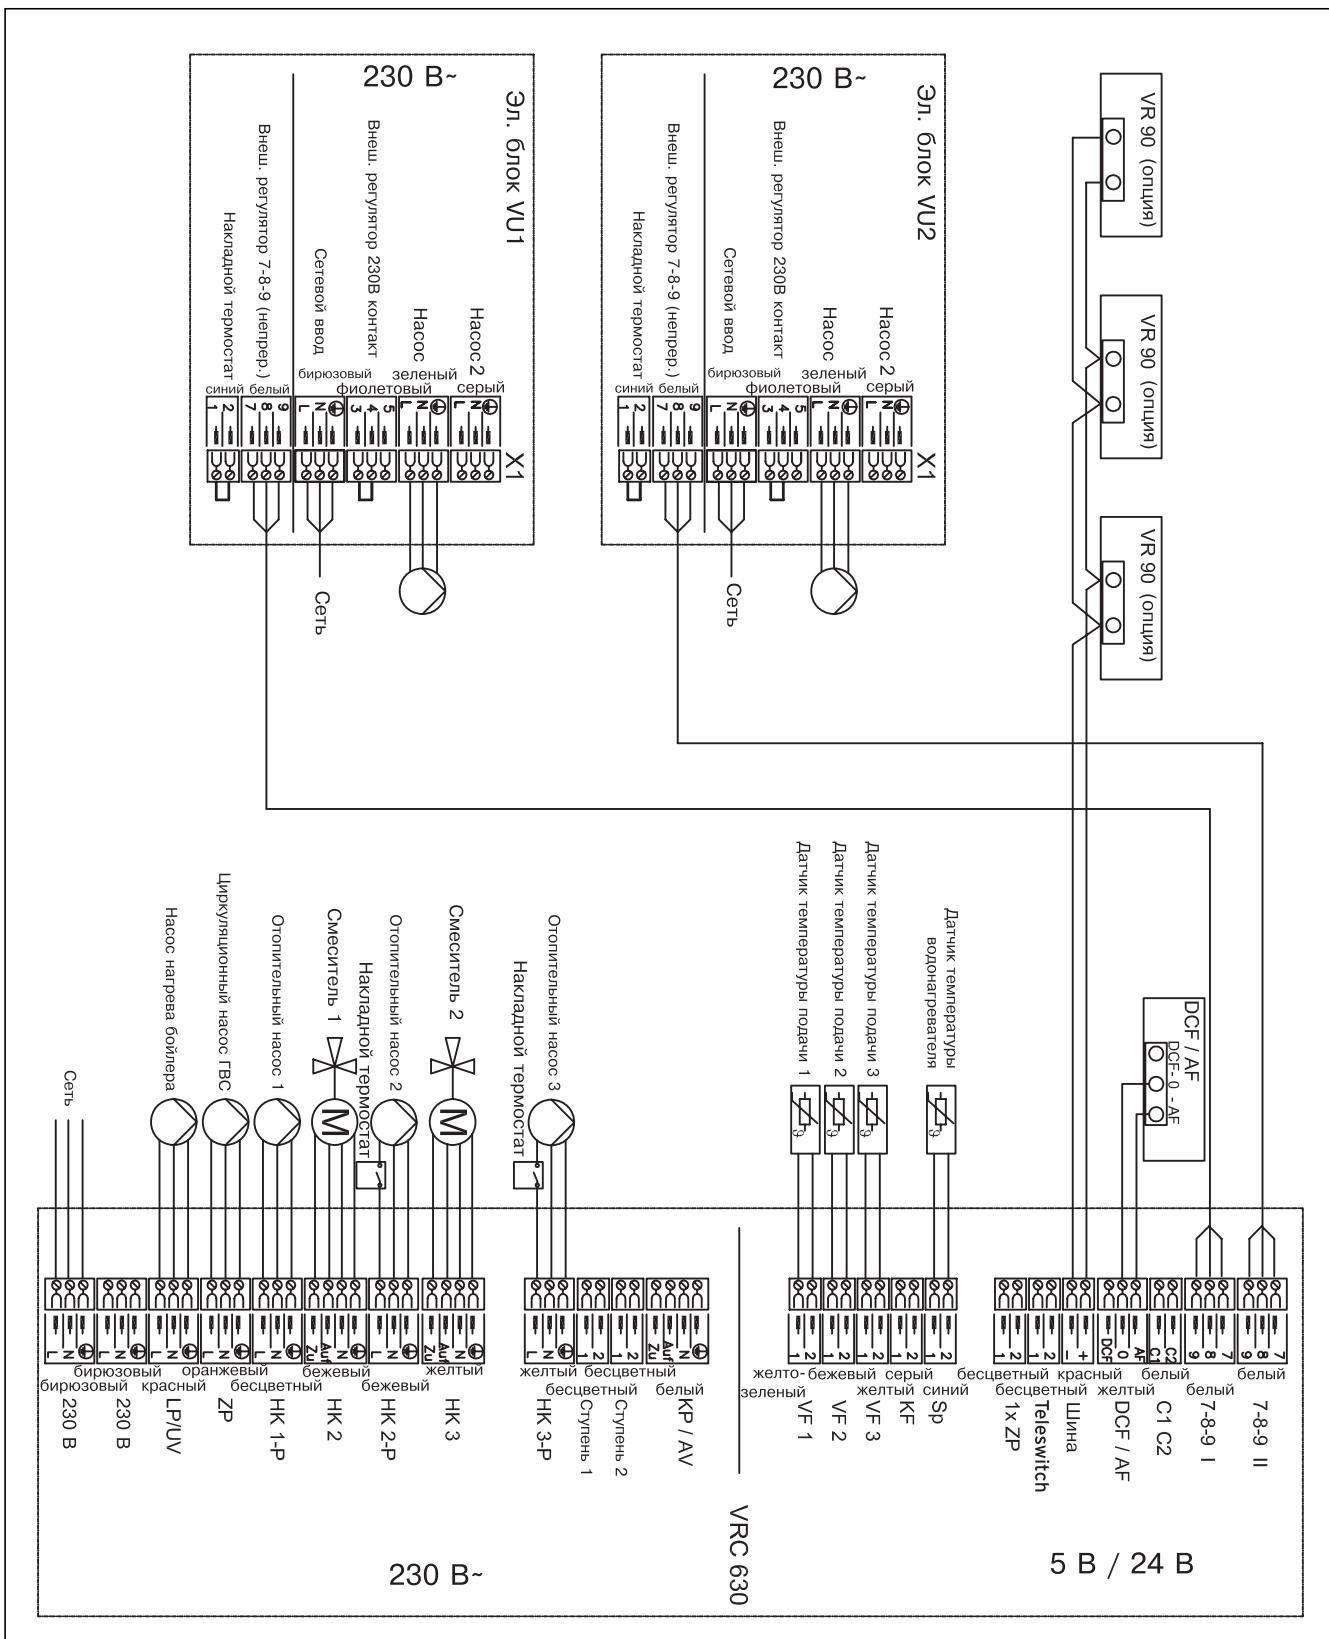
Соединительная электропроводка VRC 630, 2...VC, 3 ОК, VIH
